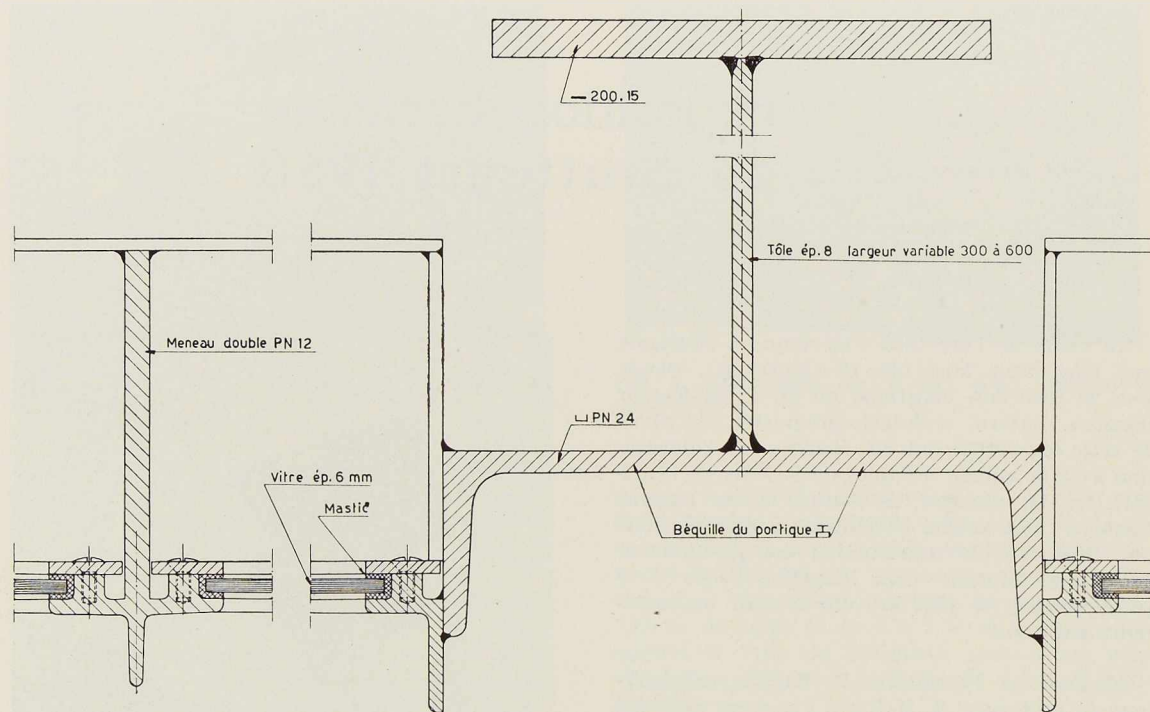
Détails constructifs de la façade vitrée principale du hall principal (voir également fig. 3 et 4).
